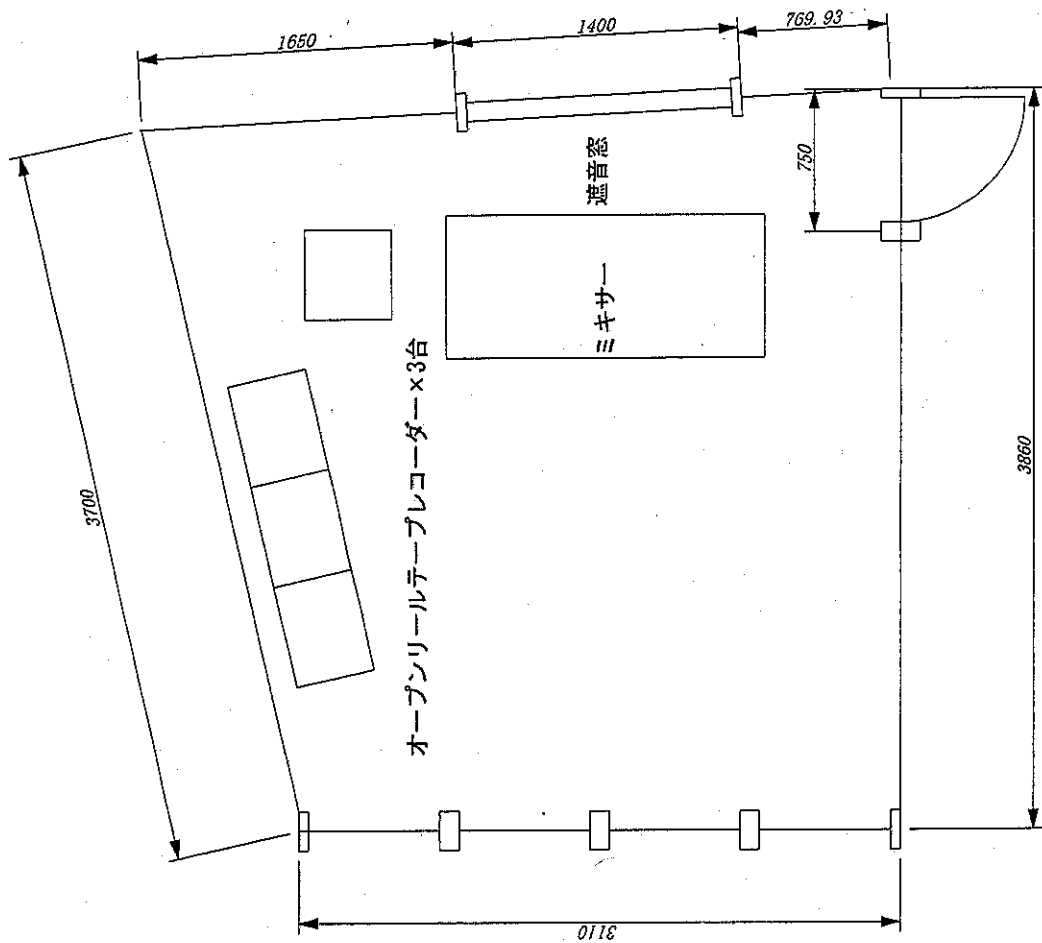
スタジオ機材設置予定平面図 (第 14 スタジオ)
